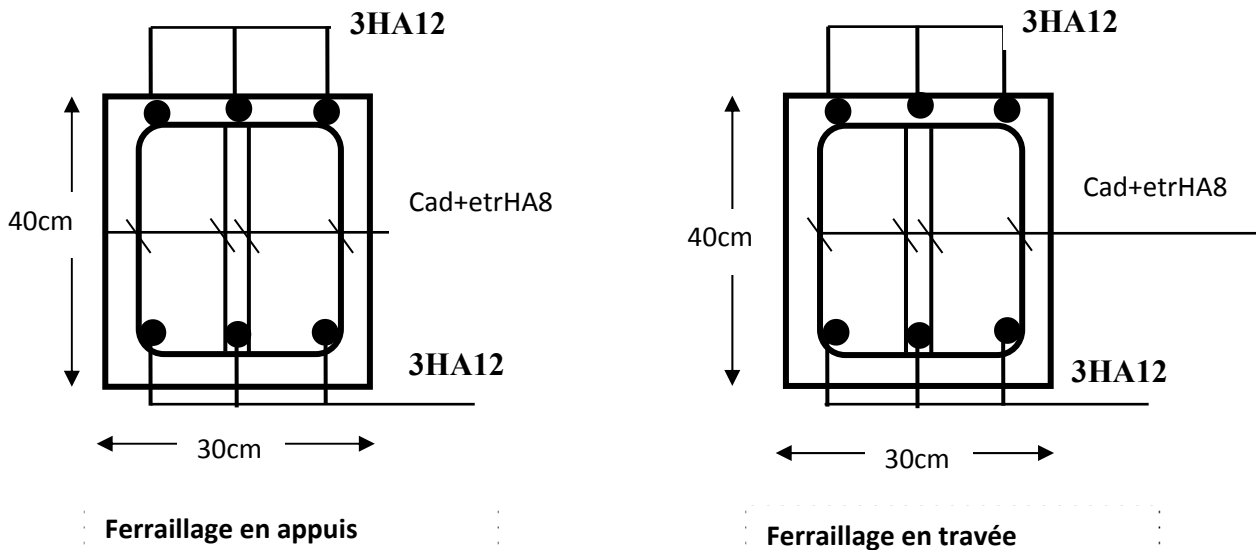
Schéma de ferrailage de la poutre palière du 5^{ème} Type d'escalier.
